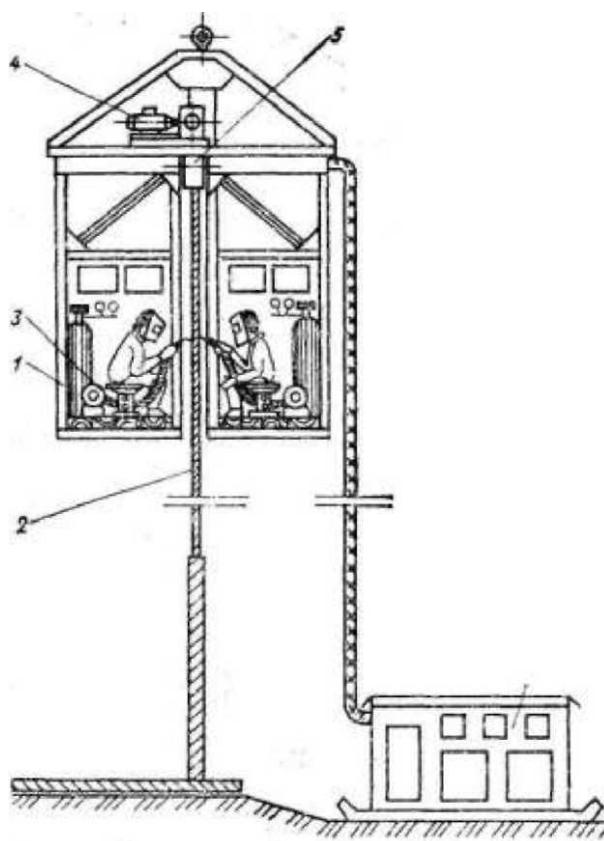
Передвижные кабины для сварки горизонтальных швов цилиндрических резервуаров
